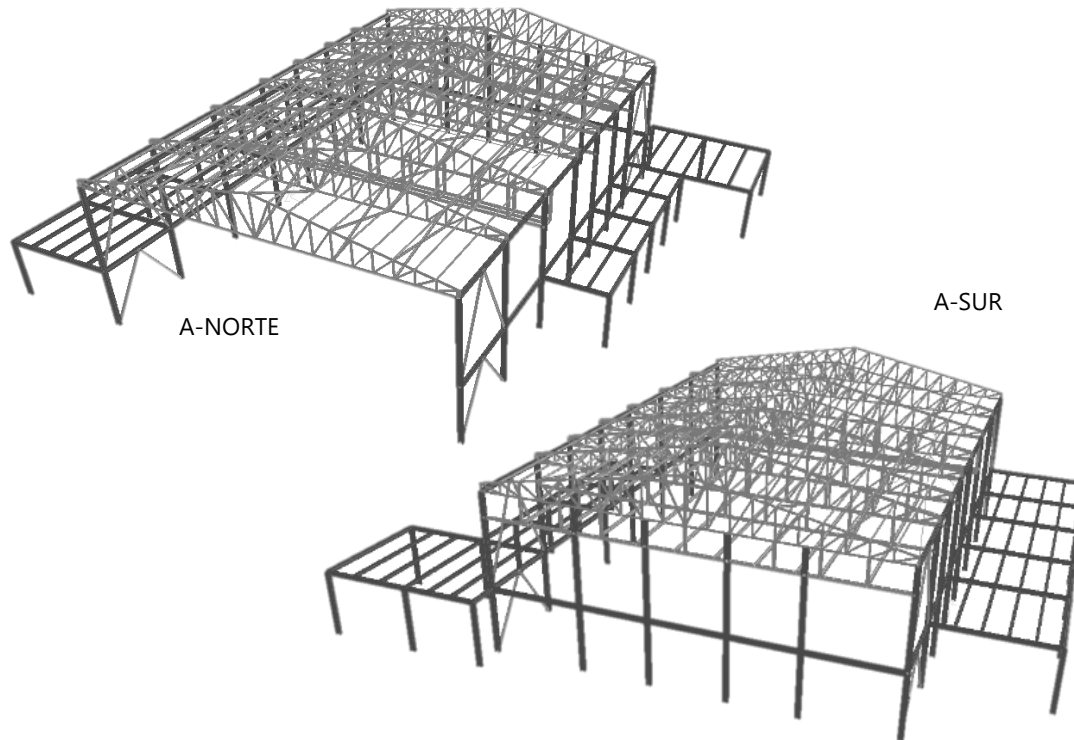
Render Staad Ala Sur y Norte del Teatro
